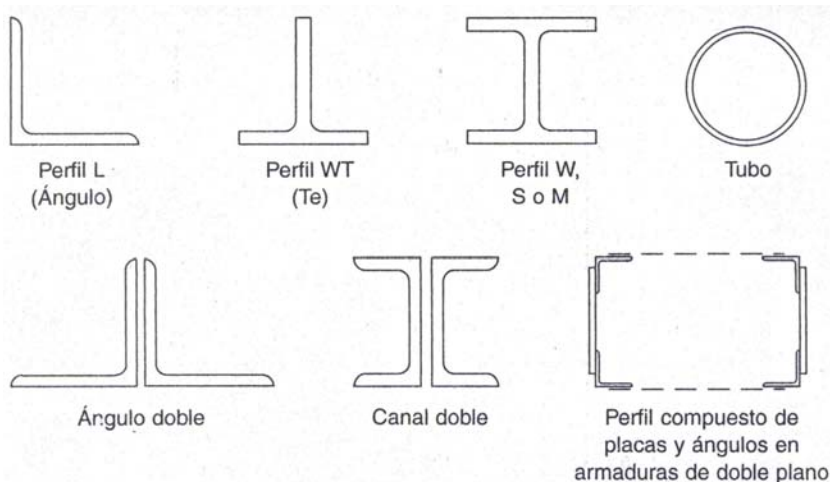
Perfiles Estructurales Usados como Miembros a Tensión
